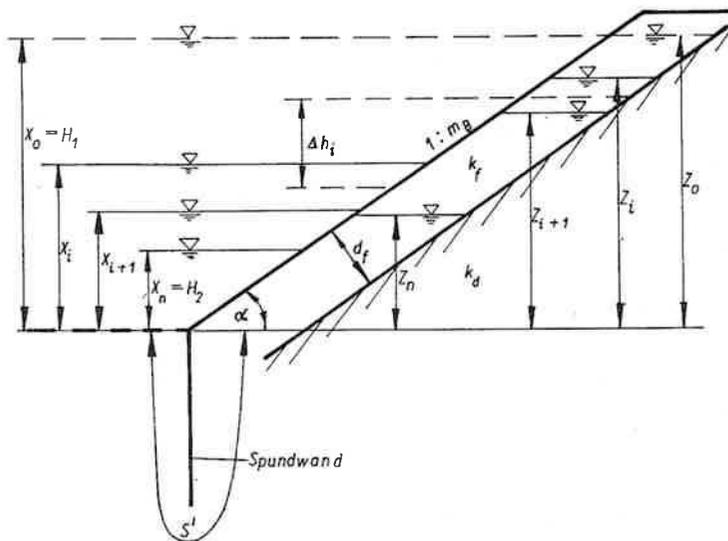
Belastung eines dichten Deckwerkes (z. B. aus Beton) durch Wasserspiegelabsenkung bei Schiffsdurchfahrt
